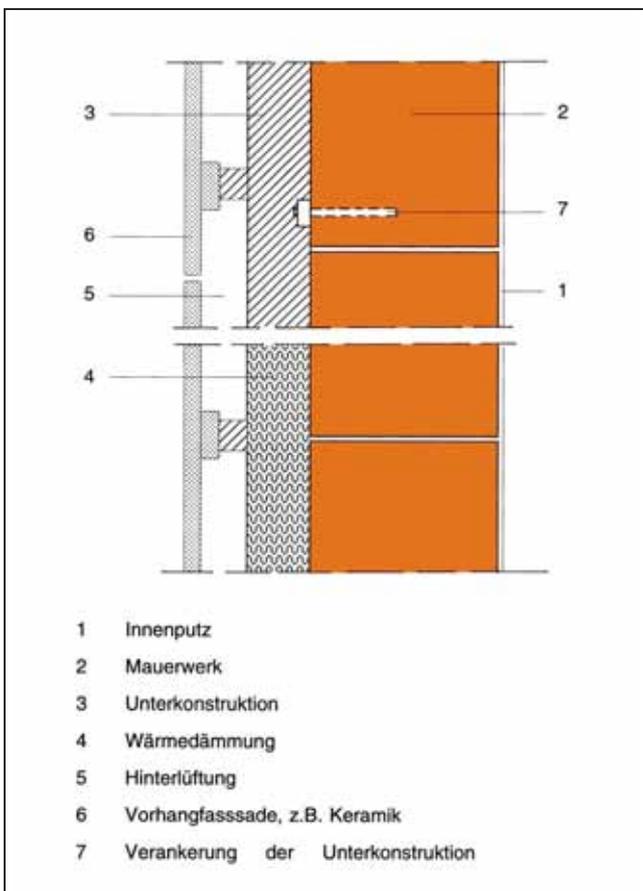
Schnitt Ziegelmauerwerk mit vorgehängter, hinterlüfteter und wärmedämmter Fassade
